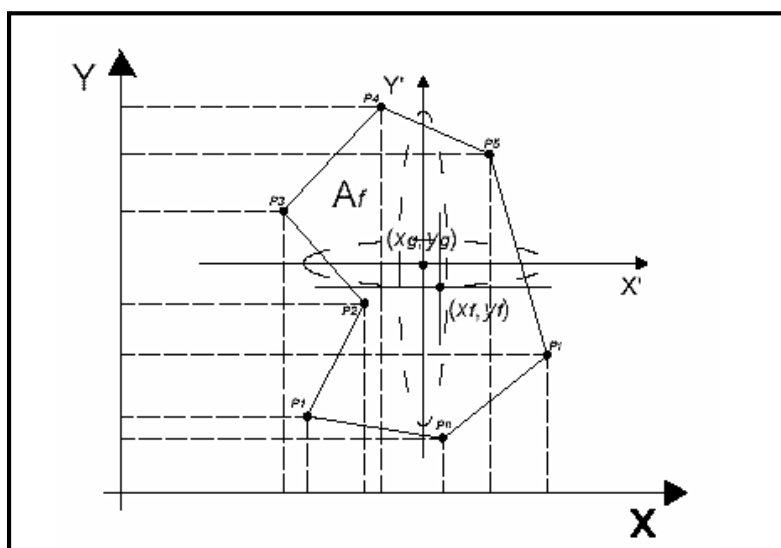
Forma general de una planta considerada para el cálculo del parámetro 6 (configuración en planta del edificio).
